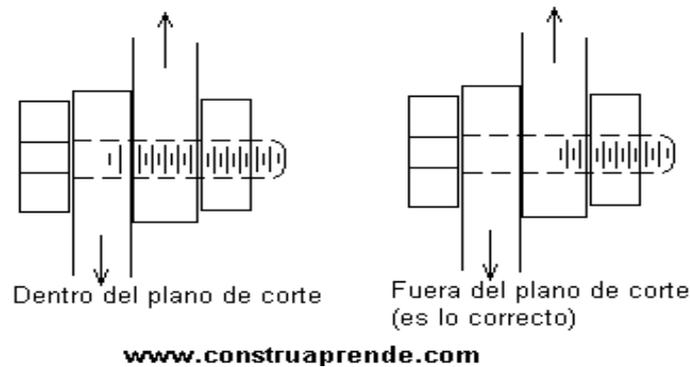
Conexiones por aplastamiento (www.ConstruAprende.com)
